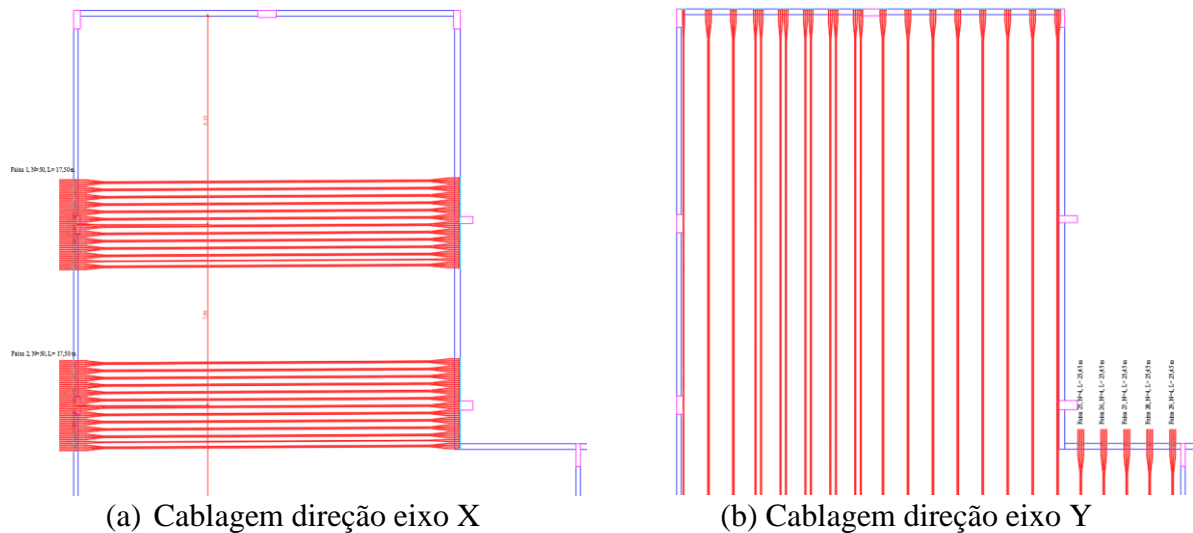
Planta do projeto original - trecho de cobertura do auditório.
